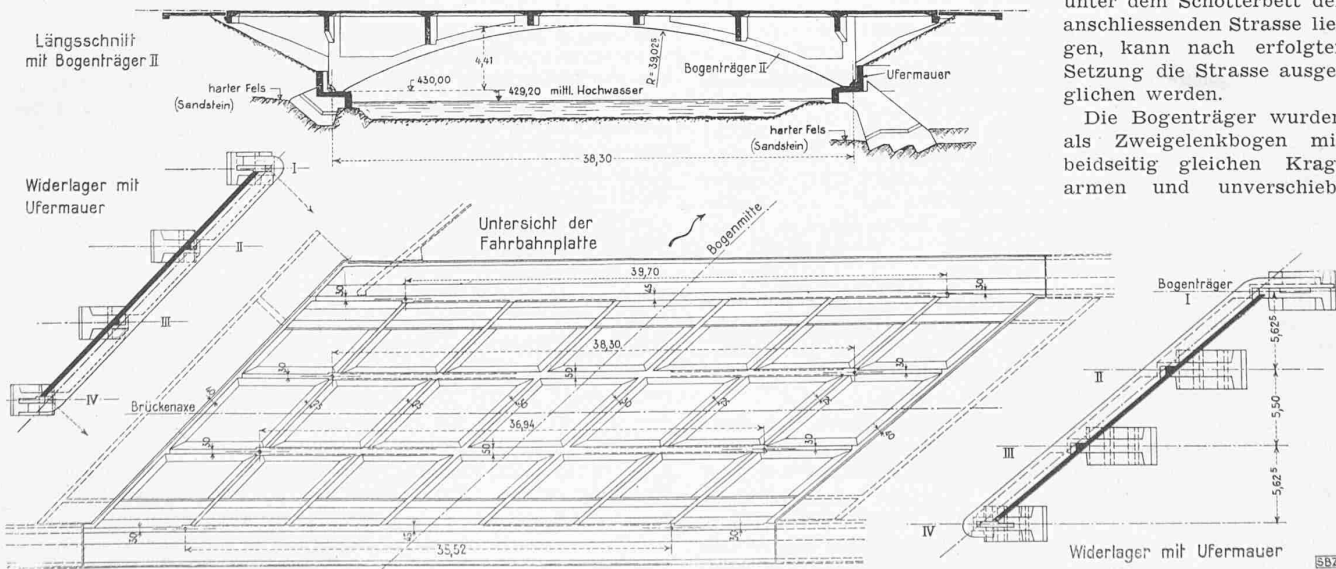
Grundriss der Brücke und der Widerlager, sowie Längsschnitt bei Bogen II, Masstab 1: 500
